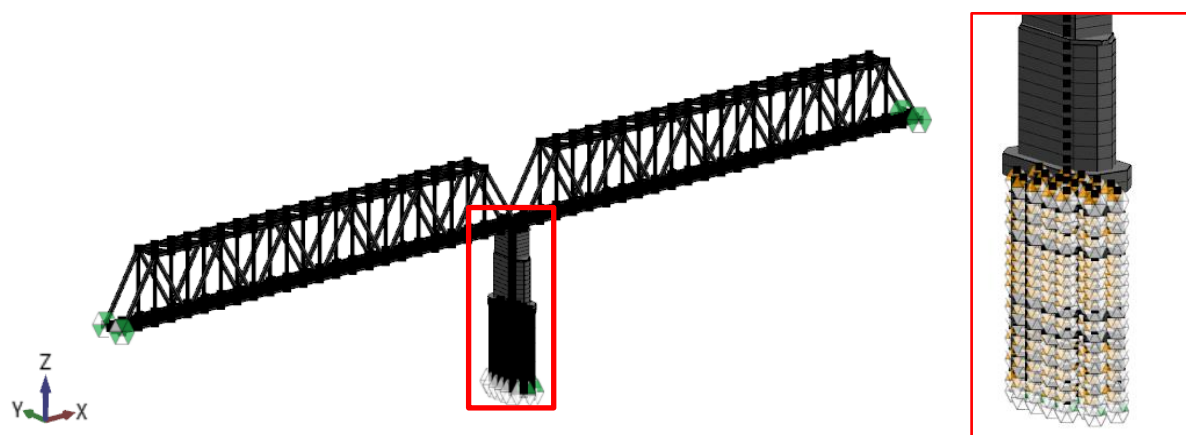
КЭ модель фрагмента моста для расчета свайного фундамента
